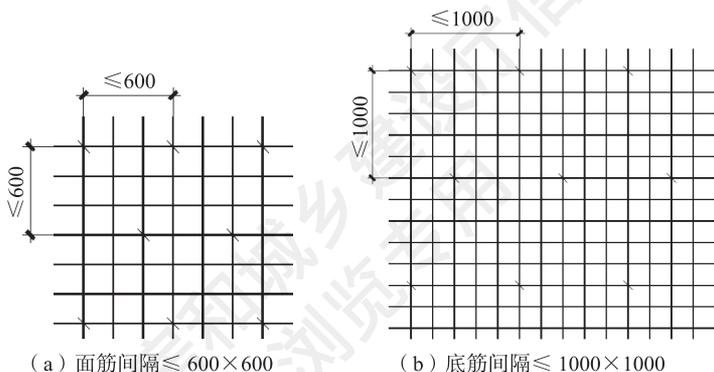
钢筋网片绑扎节点（单位：mm）
